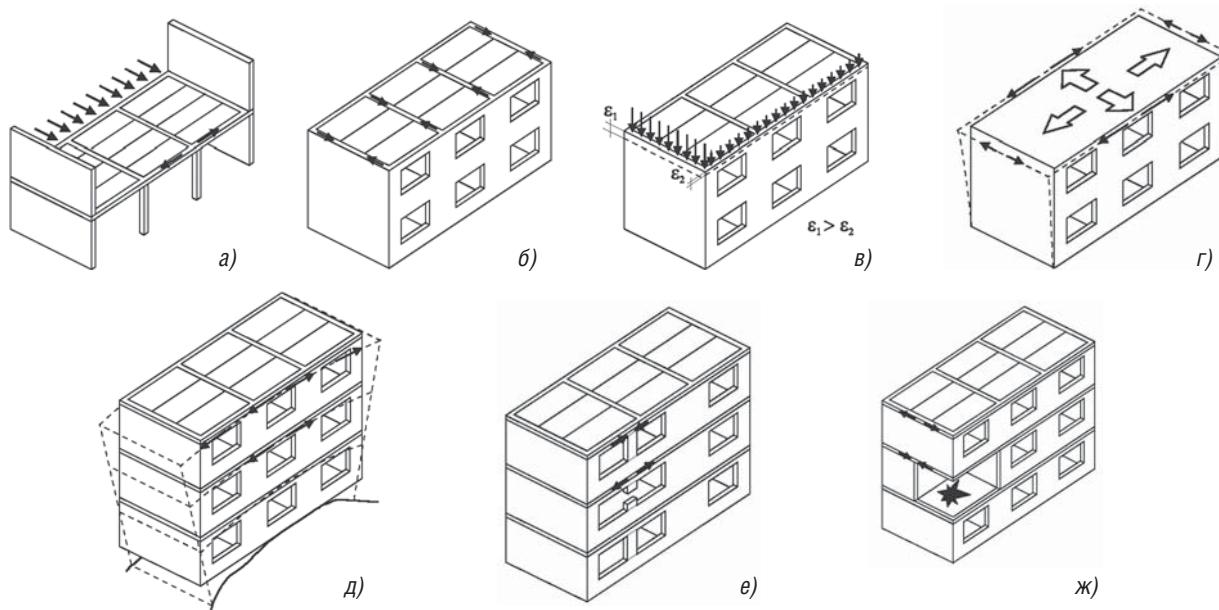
Схемы работы кольцевого анкера сборного перекрытия (стрелками обозначены направления возможных усилий и деформаций здания или его отдельных частей)
